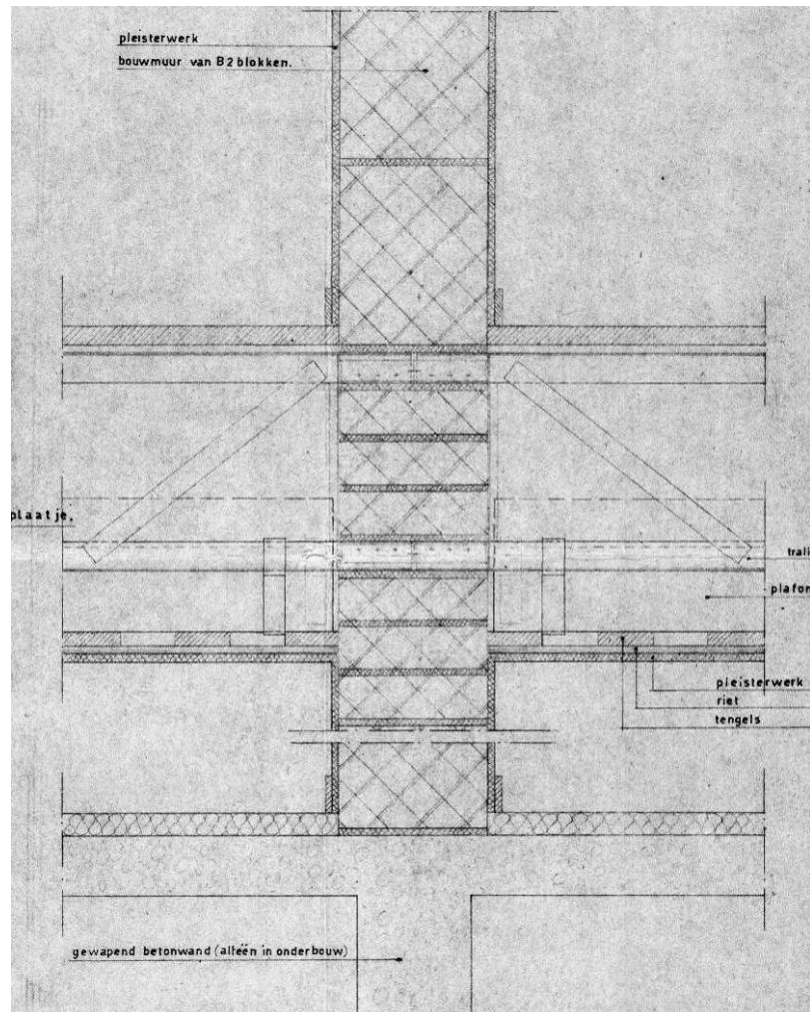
Blok B (lage blokken) de aansluiting van de vloeren op de woningscheidende wanden in B2 (beton) blokken, augustus 1956 (Bowoto 4839-01).
